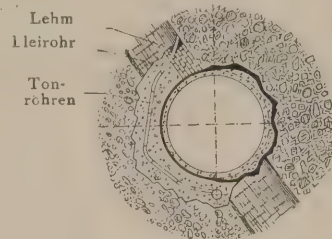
Querschnitt durch einen Druckstollen mit richtig angelegter Wasserfassung außerhalb des Profils.
